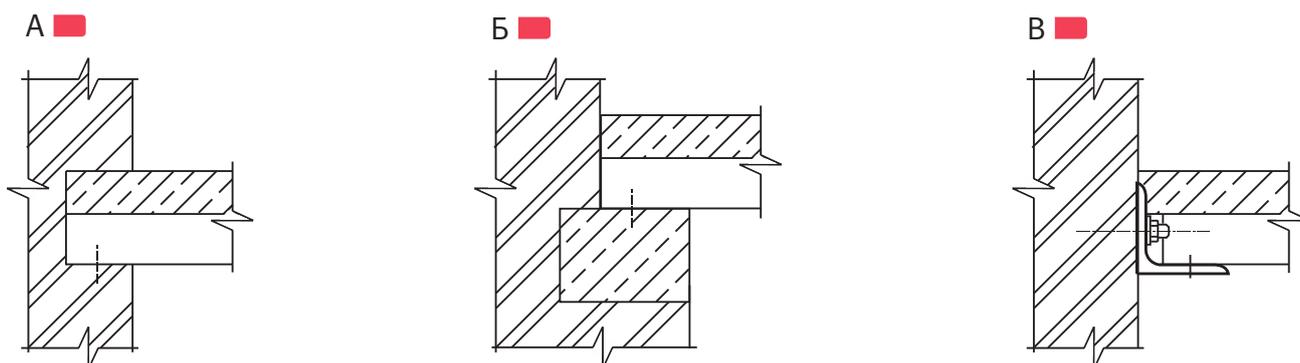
Устройство плит по профнастилу с непосредственным опиранием на стены: А – в прорезанные штробы; Б – на монолитные пояса; В – с помощью опорных контурных уголков
